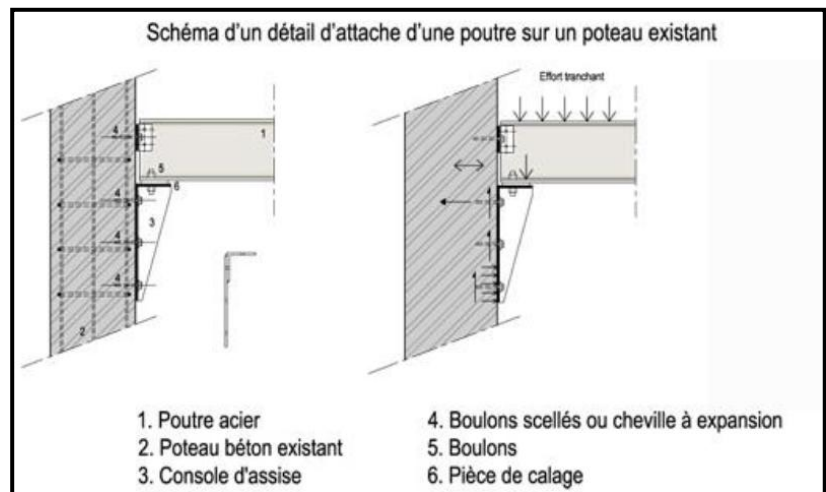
Schéma d'un détail d'attache d'une poutre métallique et un poteau en béton armé / Source : http://www.constructalia.com/francais/rehabiliter_avec_lacier/v
